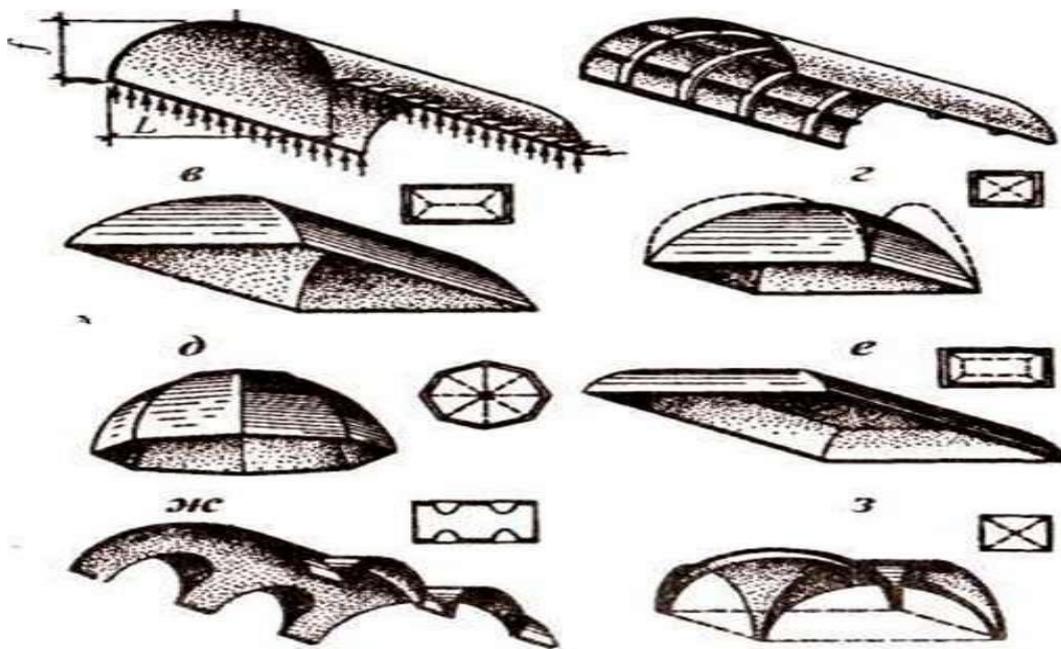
Основные формы сводов: а — гладкий свод и его опорные реакции; б — ребристый; в-д — сомкнутый; е — зеркальный; ж — цилиндрический; з — крестовый
